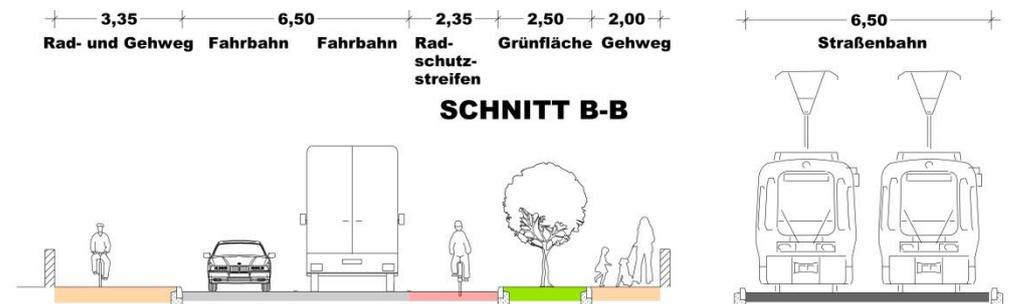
Trassenvariante 1a – Straßenquerschnitt Satower Straße (Bereich zwischen Rennbahnallee und Kringelhof, paralleler Verlauf der Straßenbahnverlängerung)
